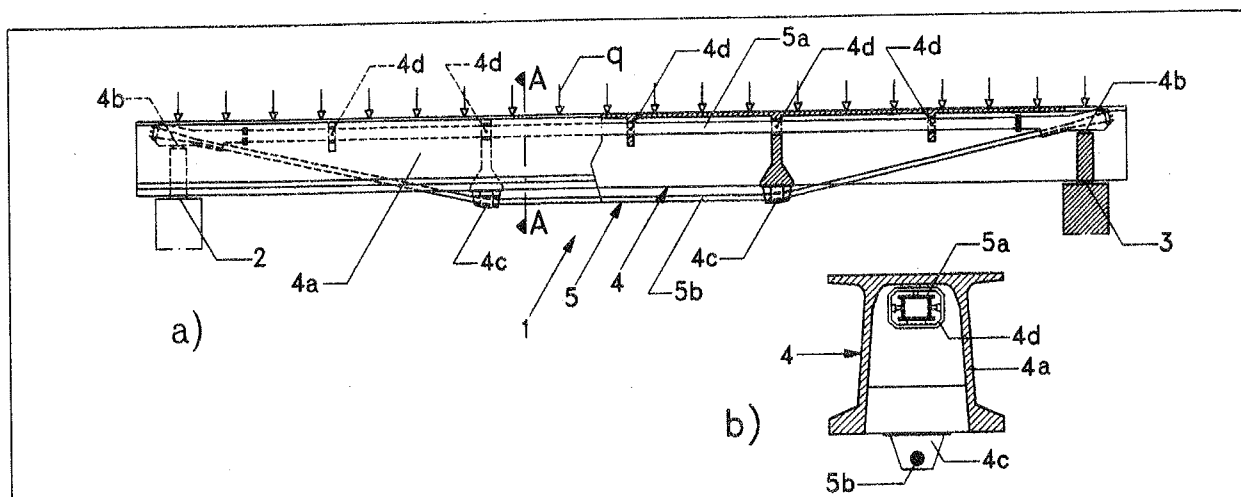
un esempio di SCSSP – a) vista e sezione longitudinale – b) sezione A-A
